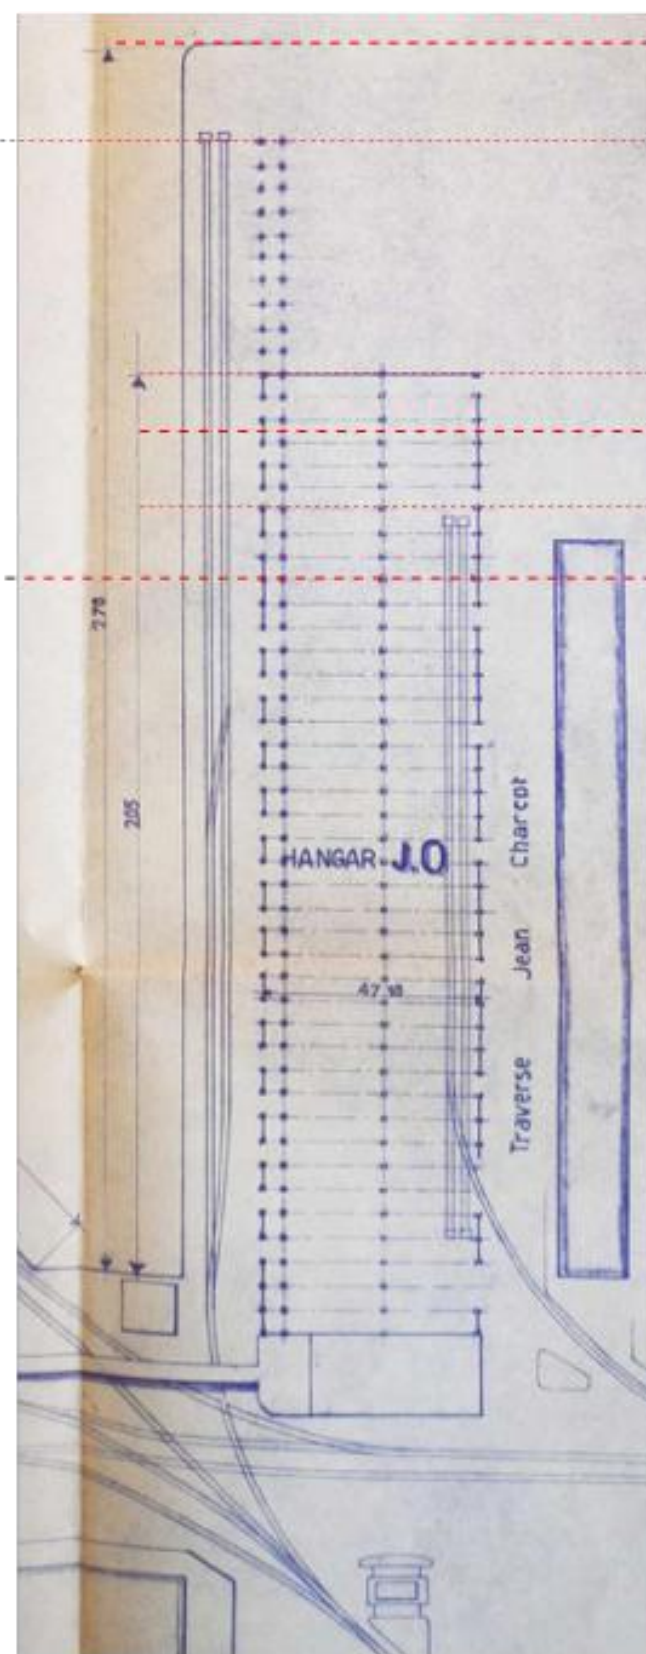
Extrait du plan d'ensemble du Bassin, Ponts et chaussées, Mr Grand, J. Cousteau - Etat actuel, 10/06/1948
